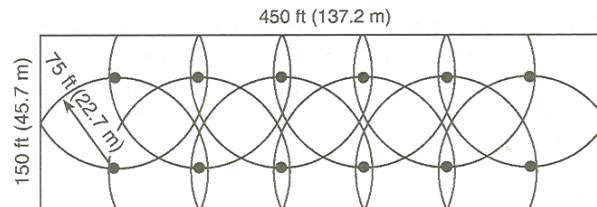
En esta configuración, que representa 12 extintores colocados en columnas o muros interiores; se cumplen conjuntamente las reglas de distribución y de distancia de recorrido.
